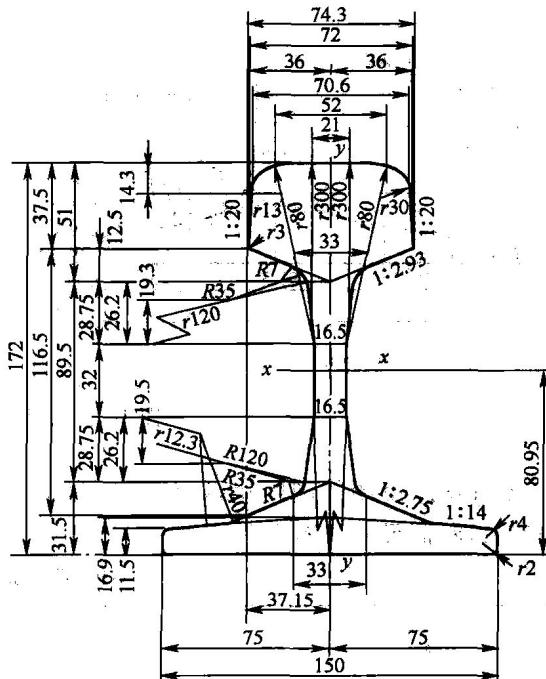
UIC60 钢轨断面图(尺寸单位:mm)
